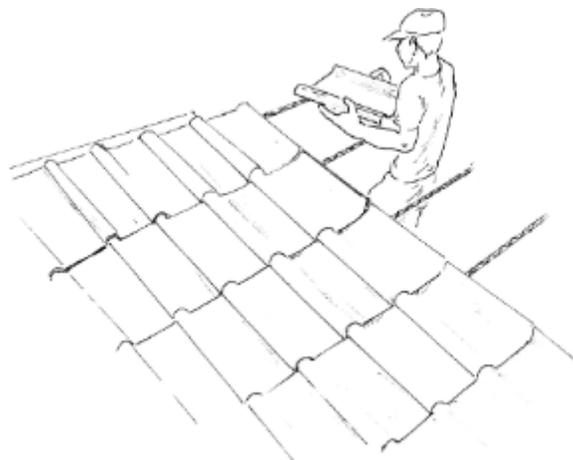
Cubierta de teja tipo romana (micro concreto).
